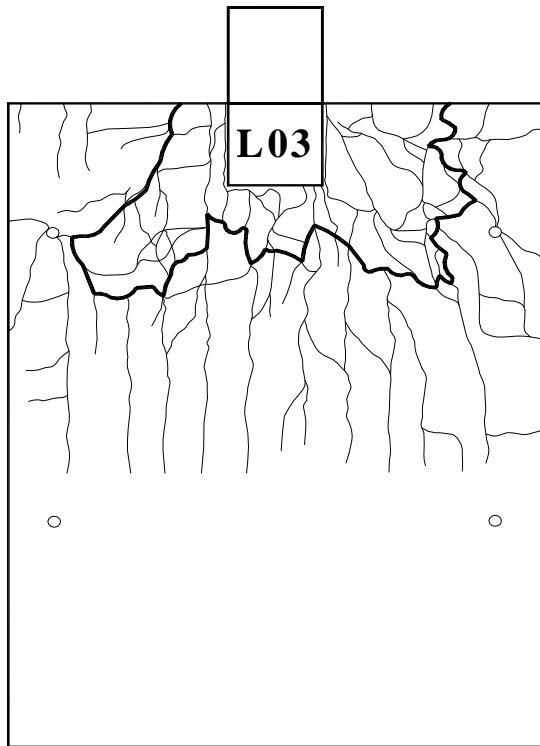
Padrão de fissuração da face superior da laje – L3
